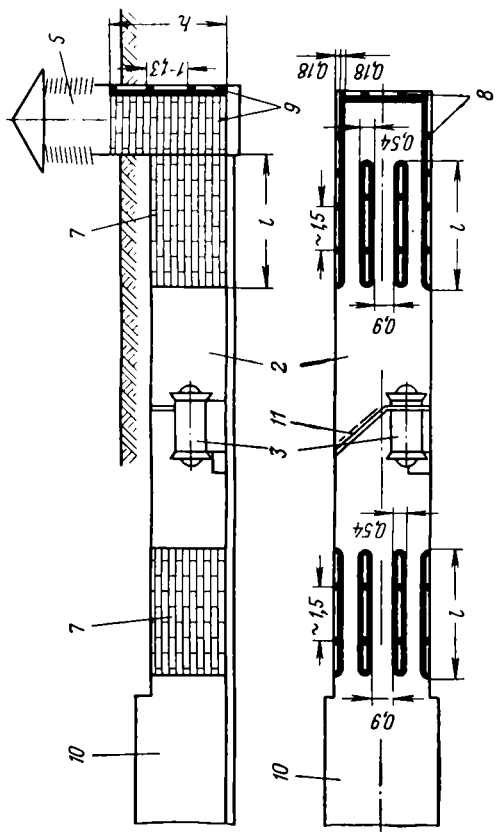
Схема размещения пластинчатых глушителей шума из бетонных шумопоглощающих блоков в вентиляционной установке тоннельной вентиляции, расположенной в туннелях мелкого заложения:
